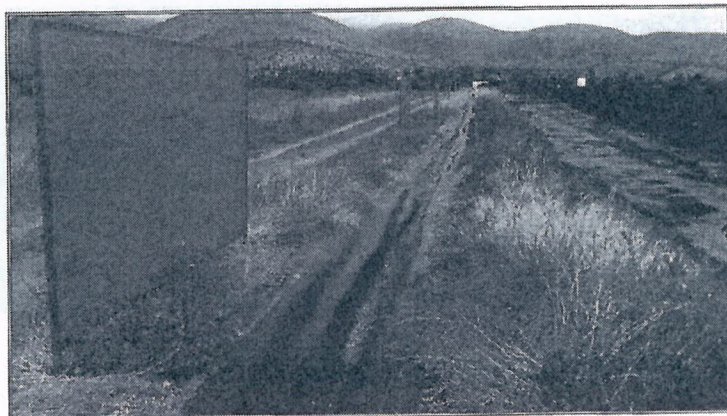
Estado actual Canal perimetral norte de oriente a poniente.
